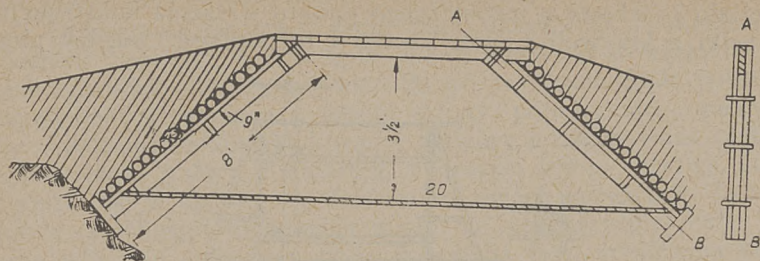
Konstrukcja lekkich belek nośnych (wg instr. z 1903 r.)
